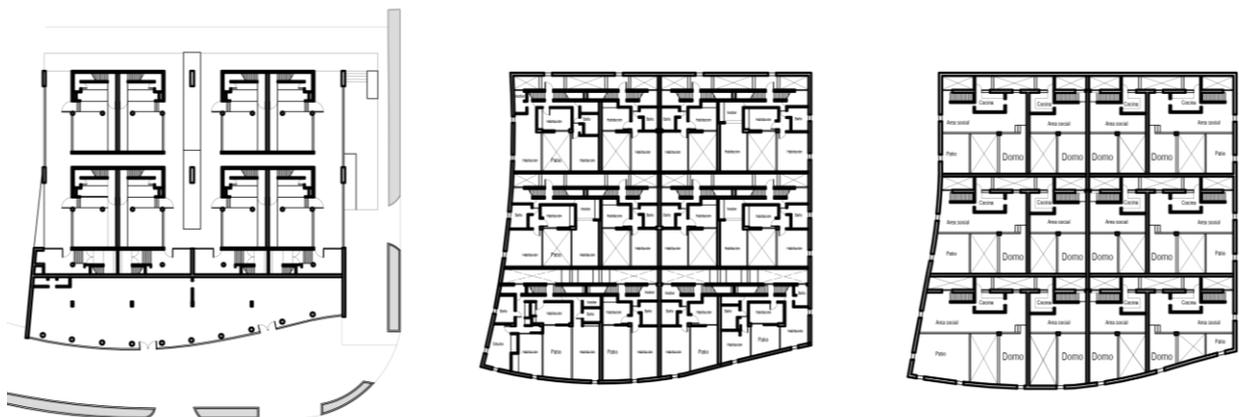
Planimetría del proyecto arquitectónico: Nexus World. Redibujo propio de la planimetría original de OMA
